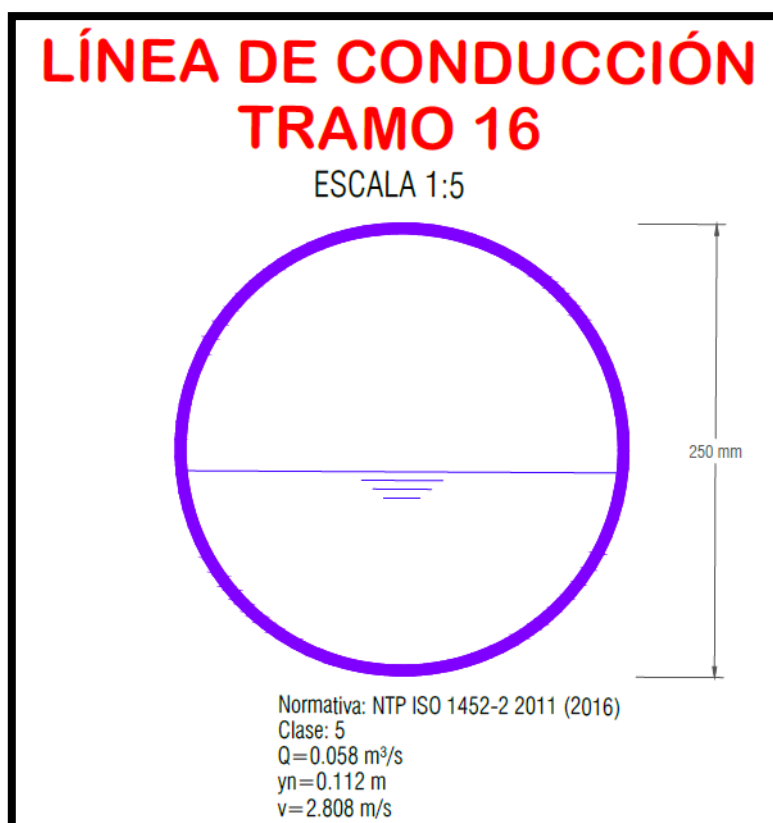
Sección típica de la tubería de PVC-U 250 mm, Tramo 16
